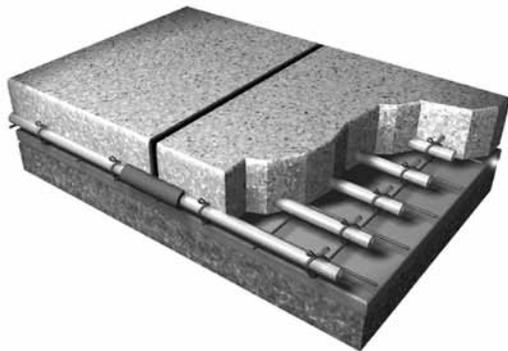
Tuyau recouvert d'isolant près d'un joint de construction
